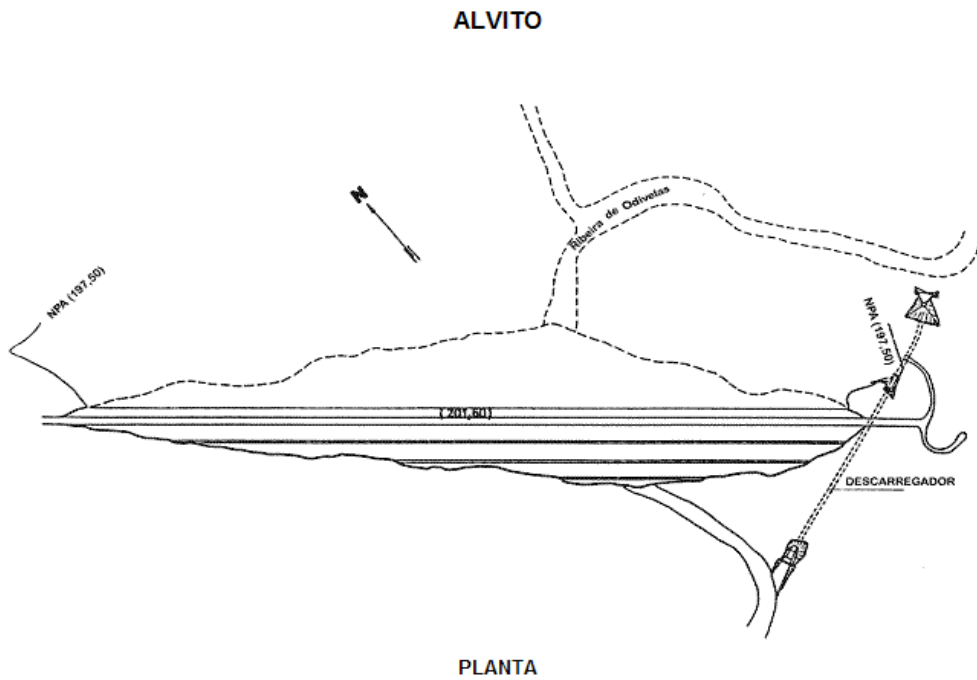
Planta geral da barragem do Alvito (Fonte APA).
